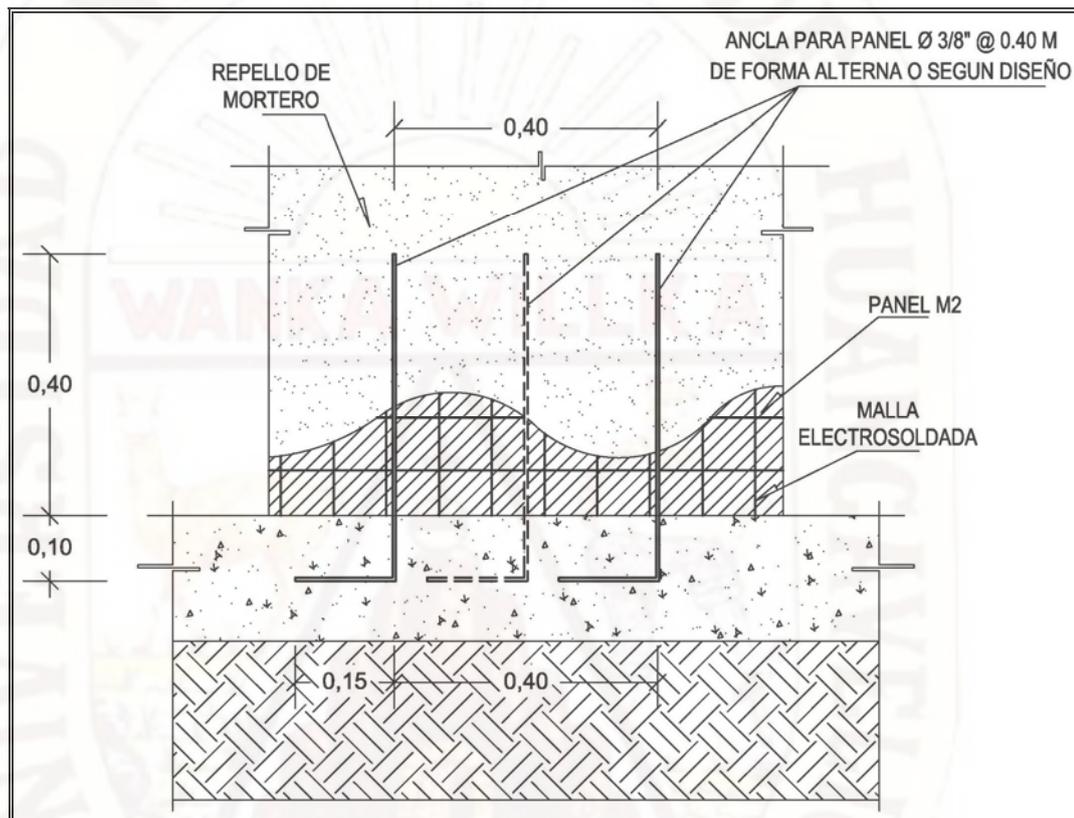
Detalles de anclaje de panel a cemento. Varillas colocadas al vaciado de mortero
